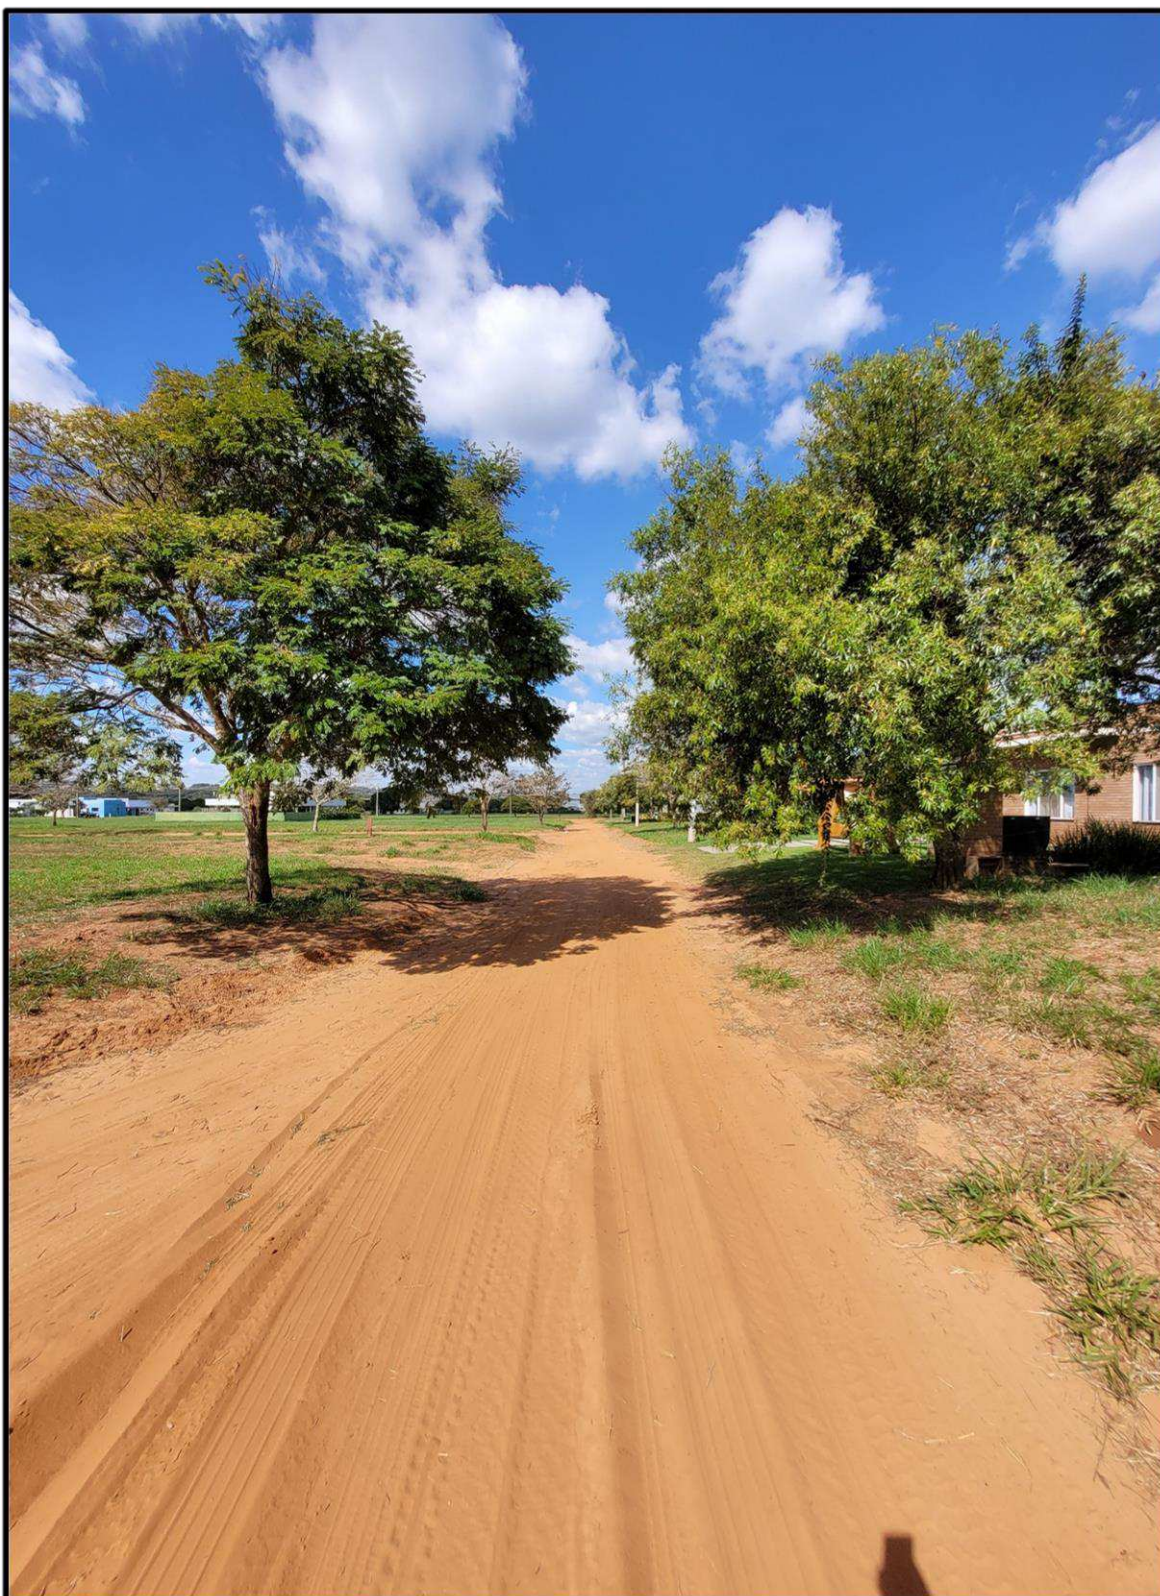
Outra vista geral da Rua Sírria, s/nº.
